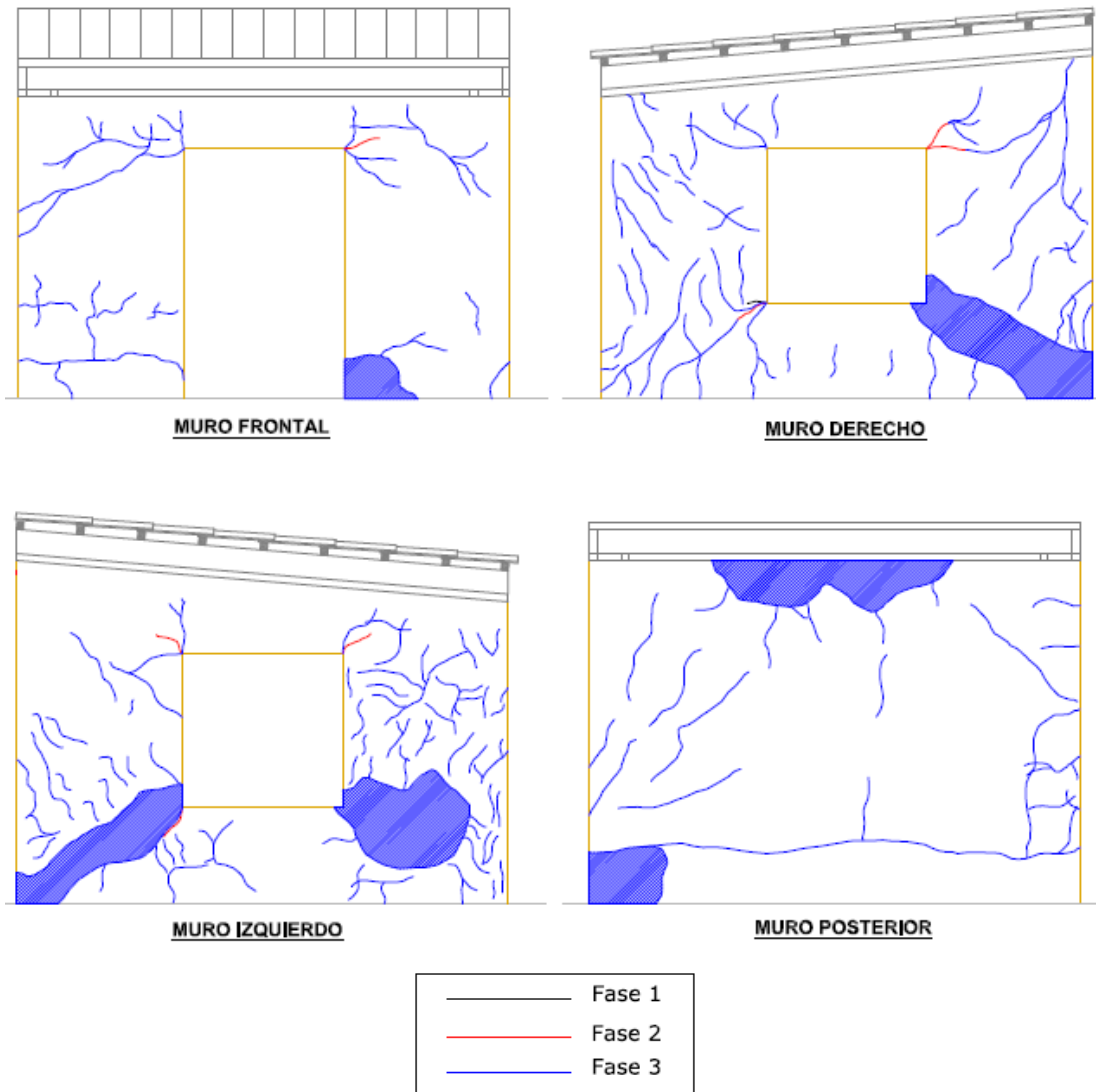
Fisuras en tarrajeo exterior – Módulo M100-T4100
